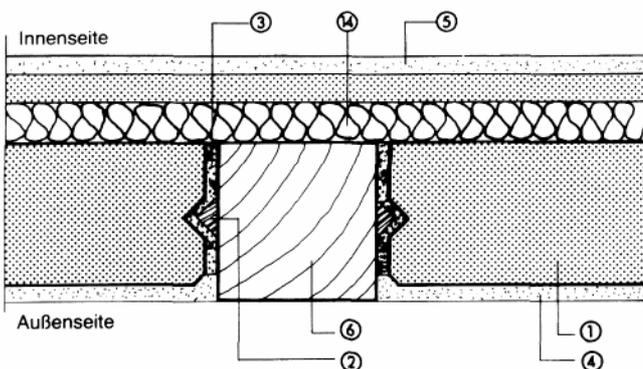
Porenbeton-Ausmauerung innen über das Fachwerk geführt
